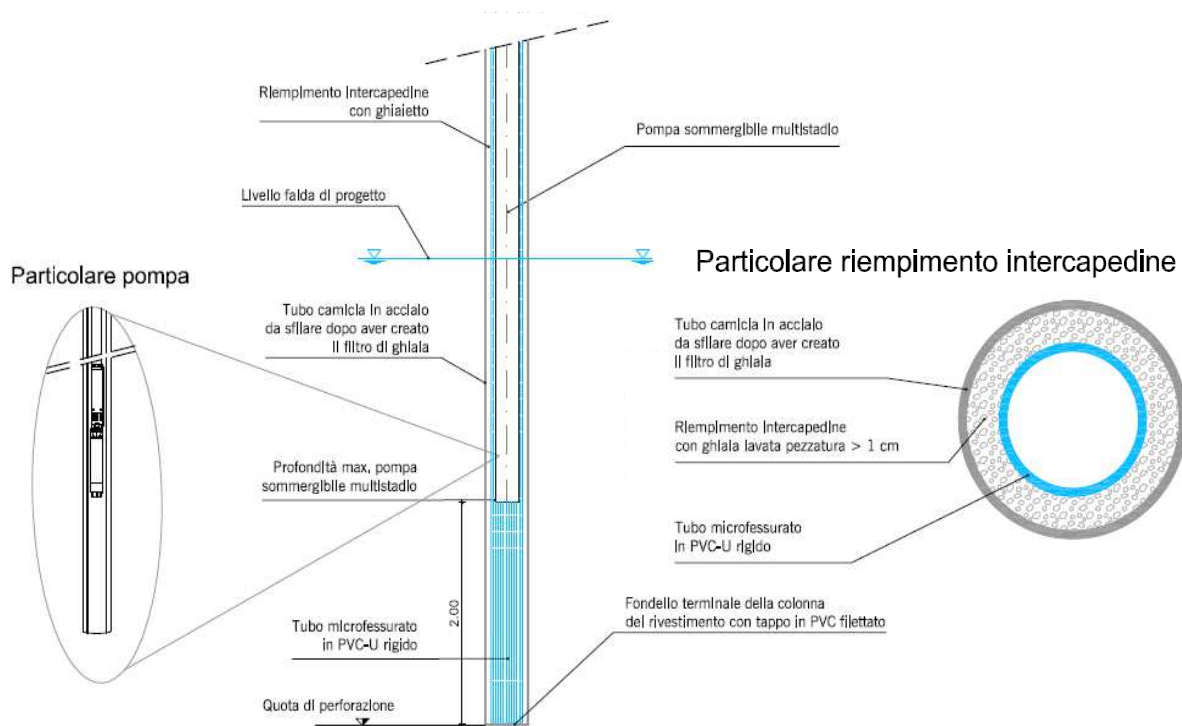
Sezione tipo del pozzo e particolare riempimento dell'intercapedine.
